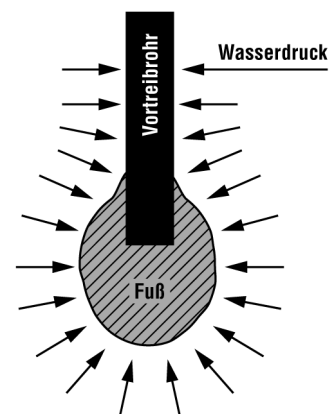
Detail Fuß mit Anschluß Rohrunterkante
